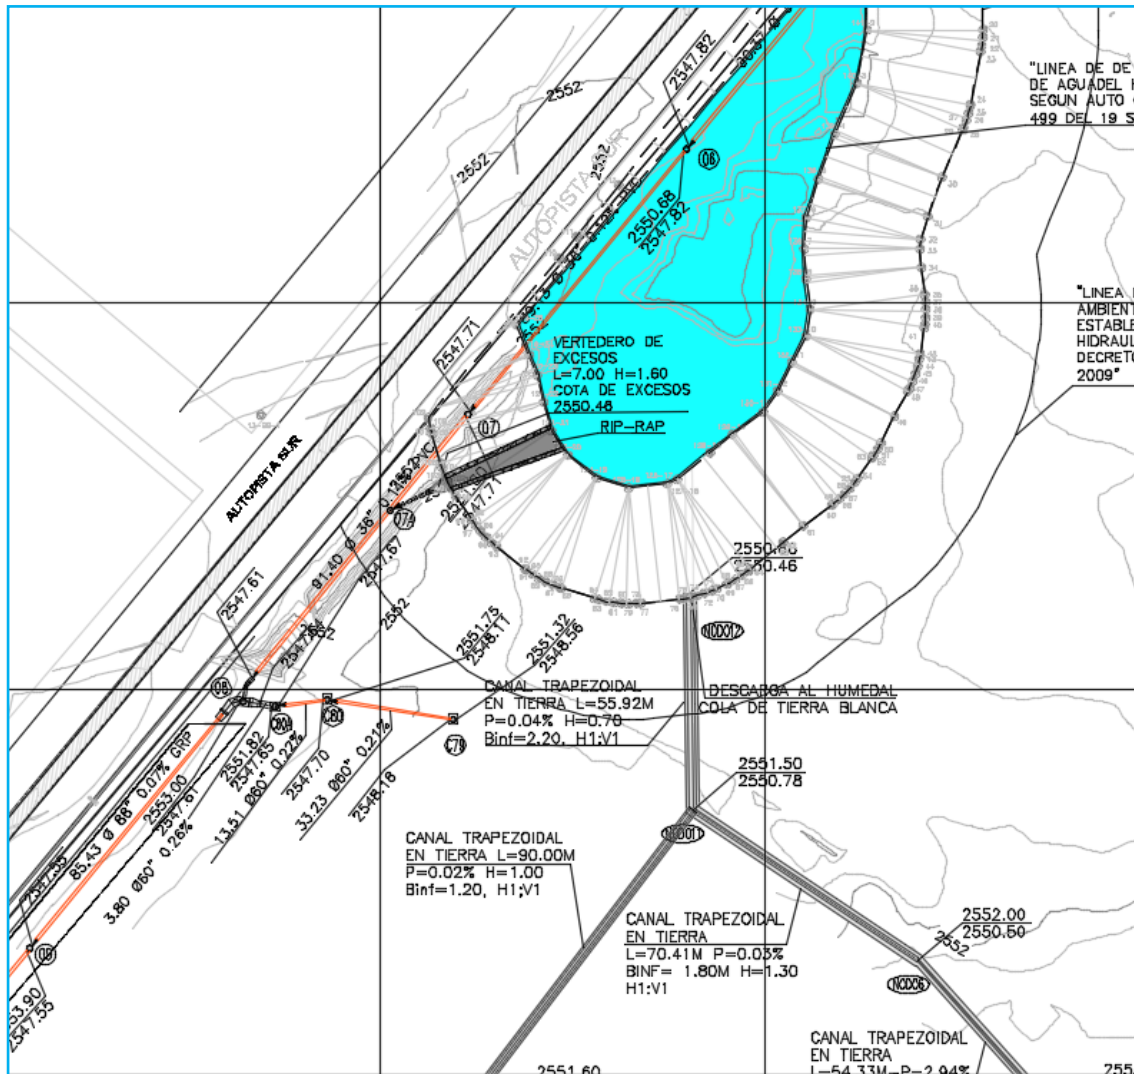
Alimentación del Humedal Cola de Tierra Blanca Mediante Canal trapezoidal Provisional Según Plano 01/10 de la Propuesta para Escenario Próximo.
